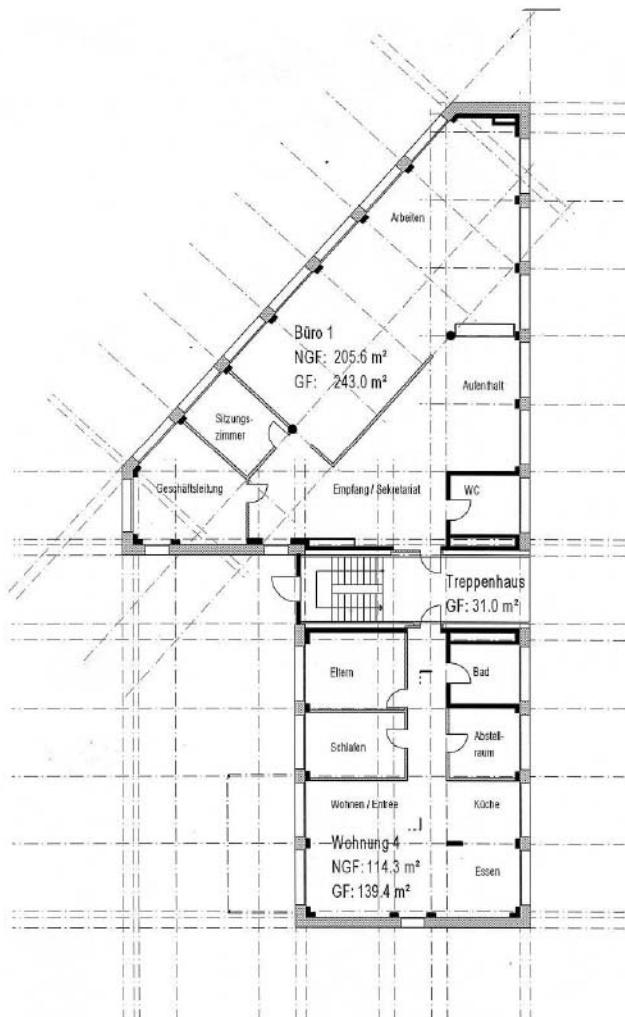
Grundriss des Passivhaus Rapperswil mit unbeheiztem Treppenhaus in der Mitte [16]
